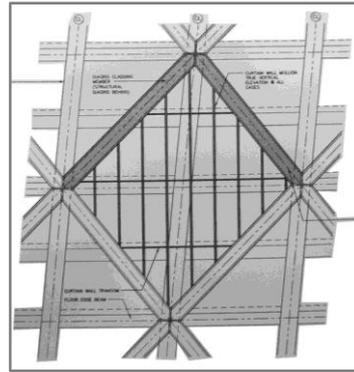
, äußeres Strebesystem mit Curtainwall – Element
